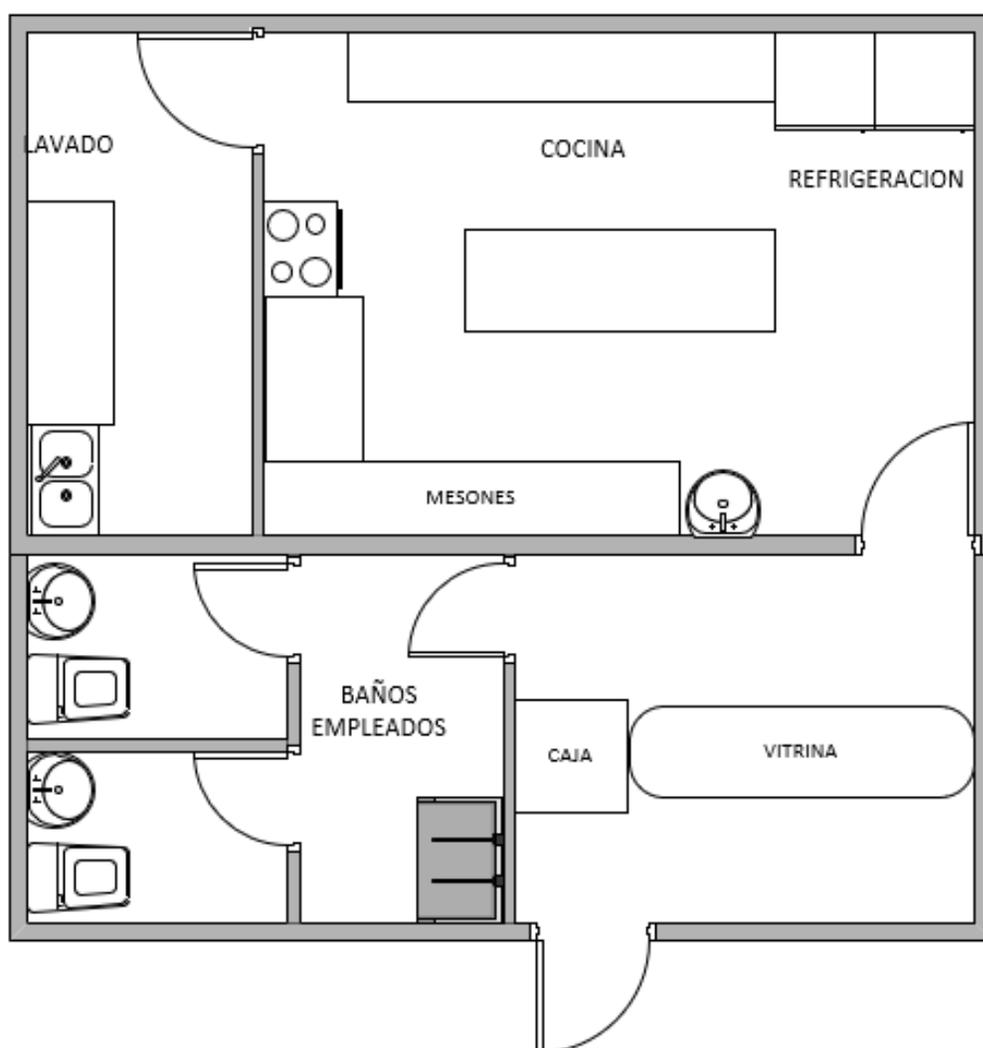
Layout propuesto para la Pastelería. Elaboración propia
